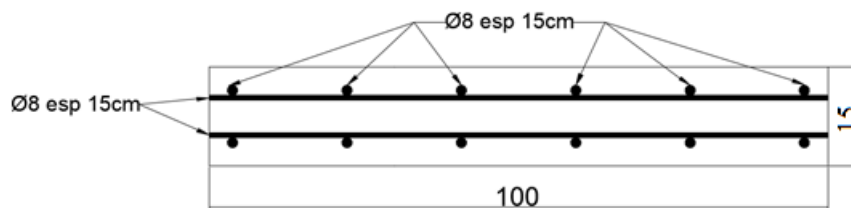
Ferrailage de la dalle triangulaire (cm).
